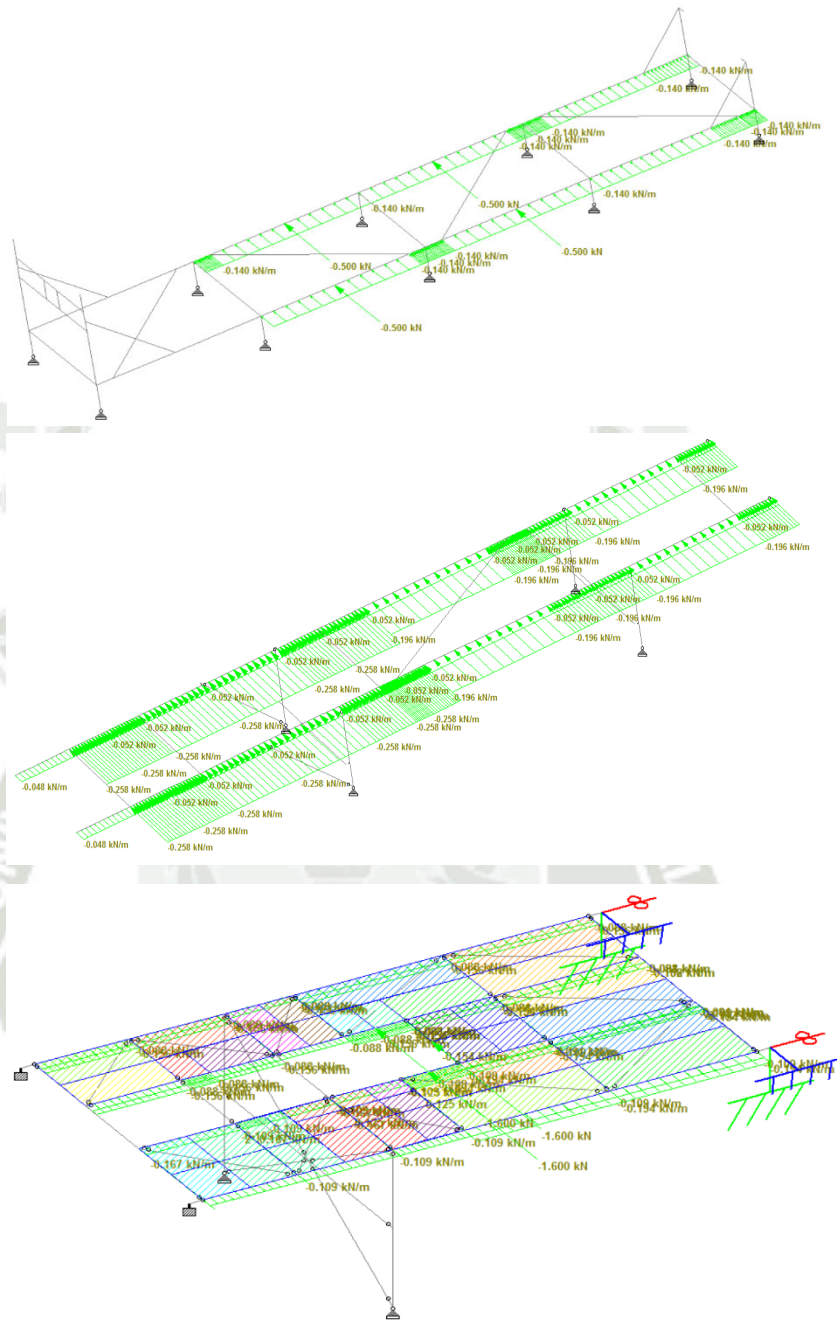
Carga Tipo 17 (E+Z) Aplicada a la estructura
